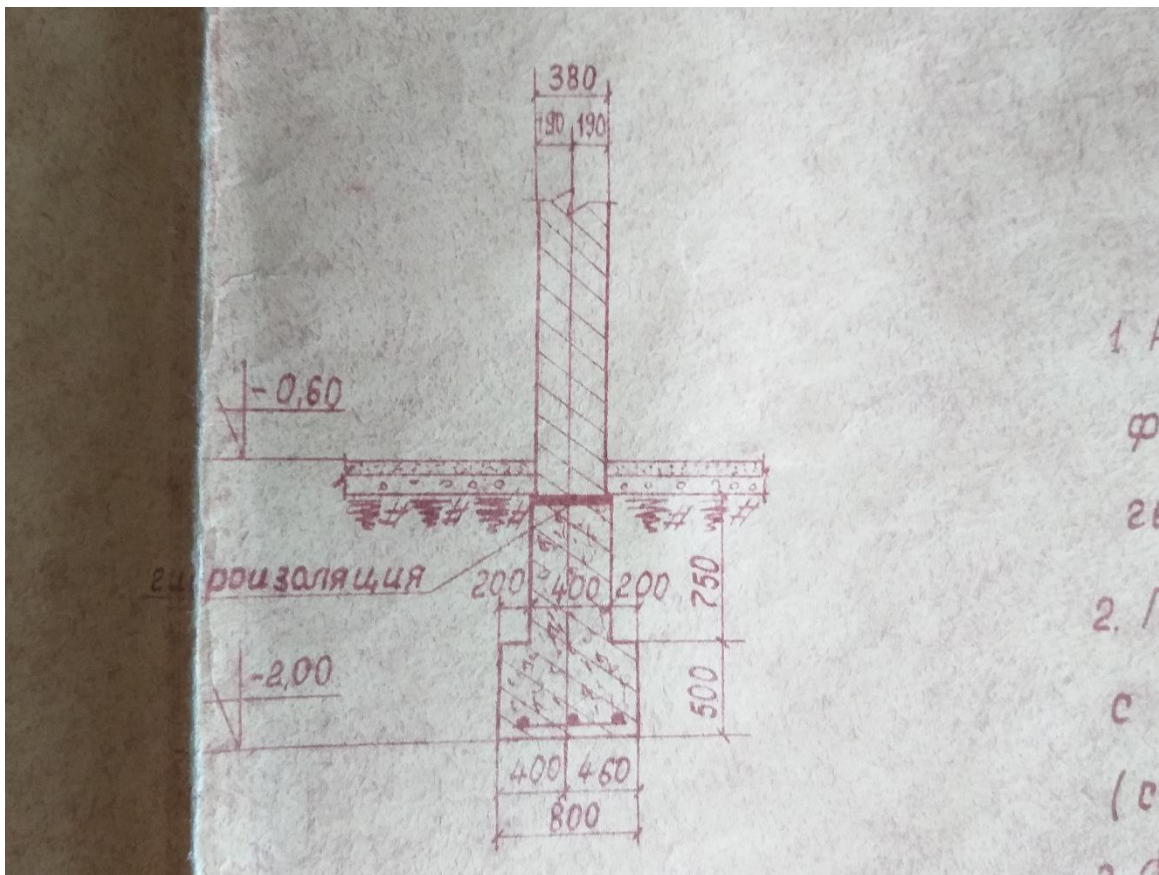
Сечение нового фундамента под внутренние стены согласно проекту
